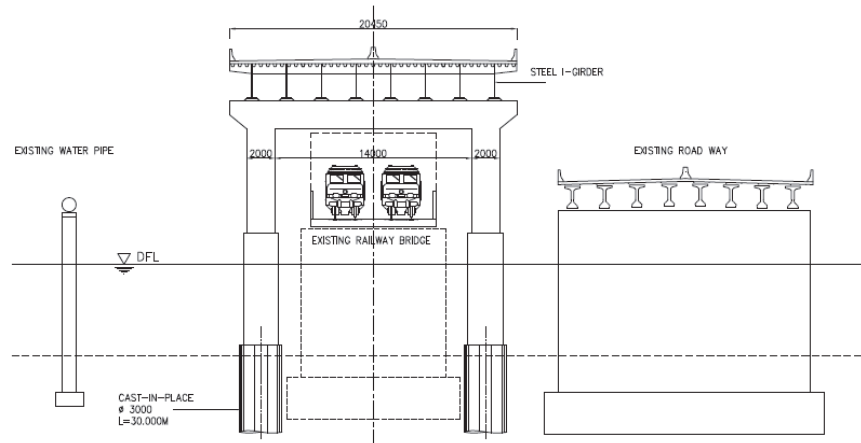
河川部標準断面図（既設橋脚との位置関係）
